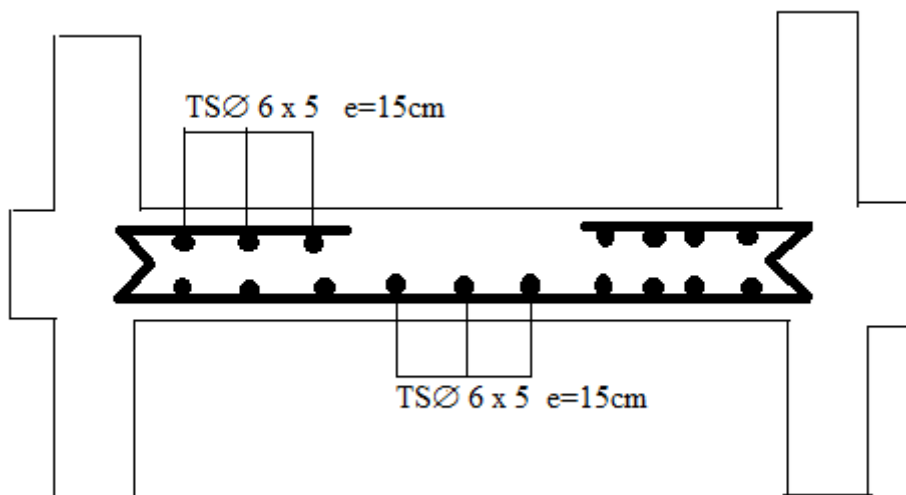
Schéma du ferrillage de la dalle plancher étage courant.
